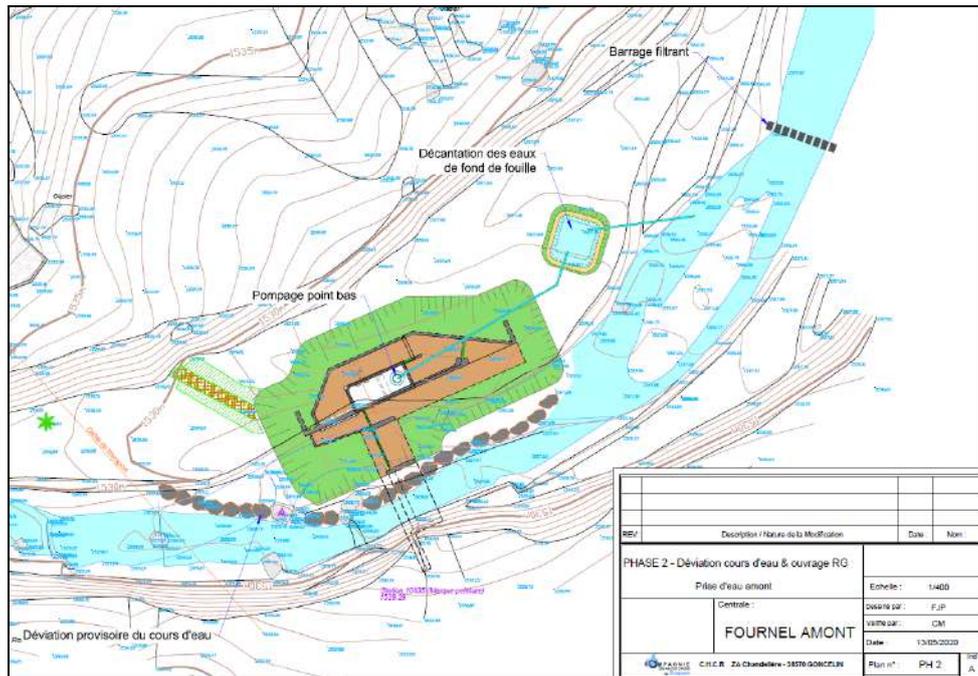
Phasage des travaux au niveau de la PE amont – Construction des ouvrages rive gauche
